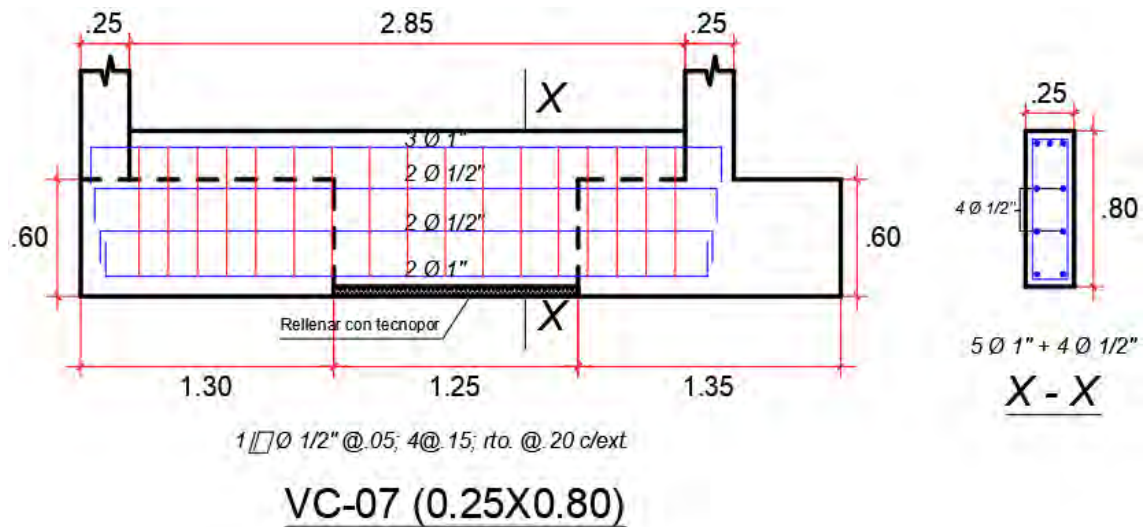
Distribución de refuerzos para viga de cimentación VC-07
